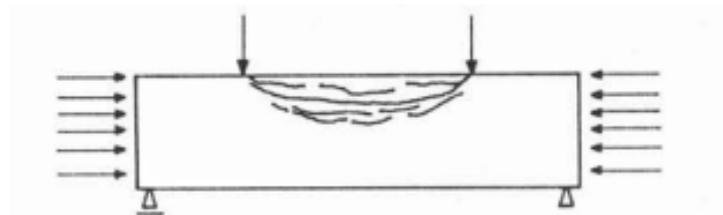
Fissuras provocadas por esforços de flexão e cisalhamento
